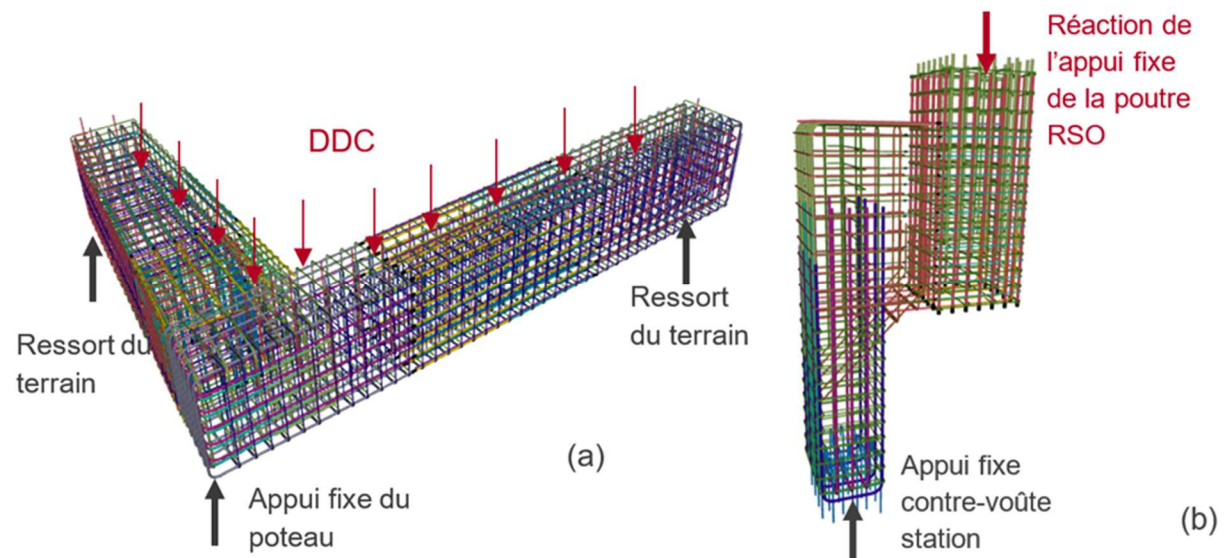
Vues 3D de la poutre contre-voile – Coffrage et ferrillage
